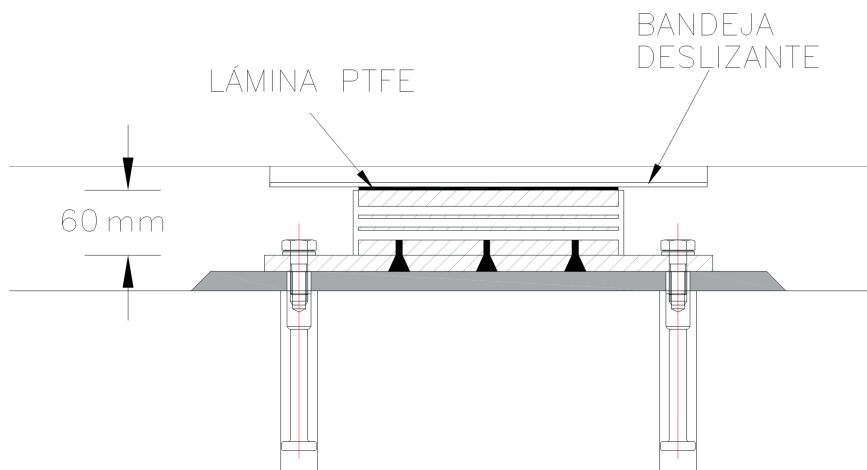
Esquema de apoyos anti-levantamiento (apoyos superiores)
